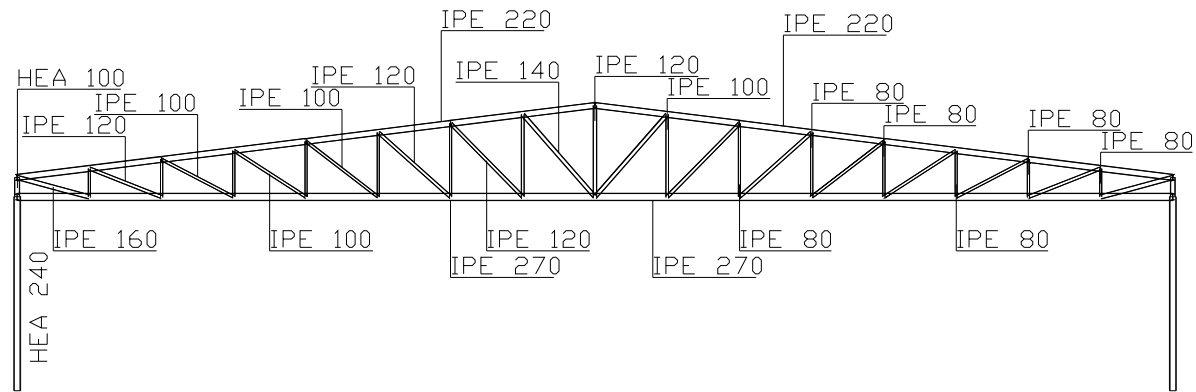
Pórtico com pilar de alma cheia, viga em treliça, vão de 40.00m, pilar em perfil com secção transversal HEA, viga em perfil com secção transversal IPE.
